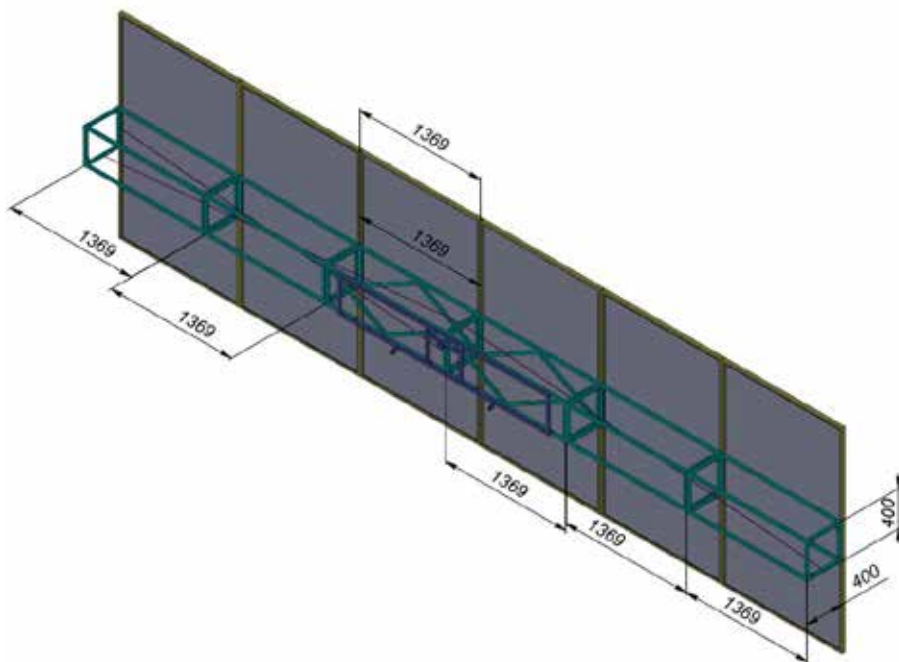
Кріплення ферми несучої конструкції із
